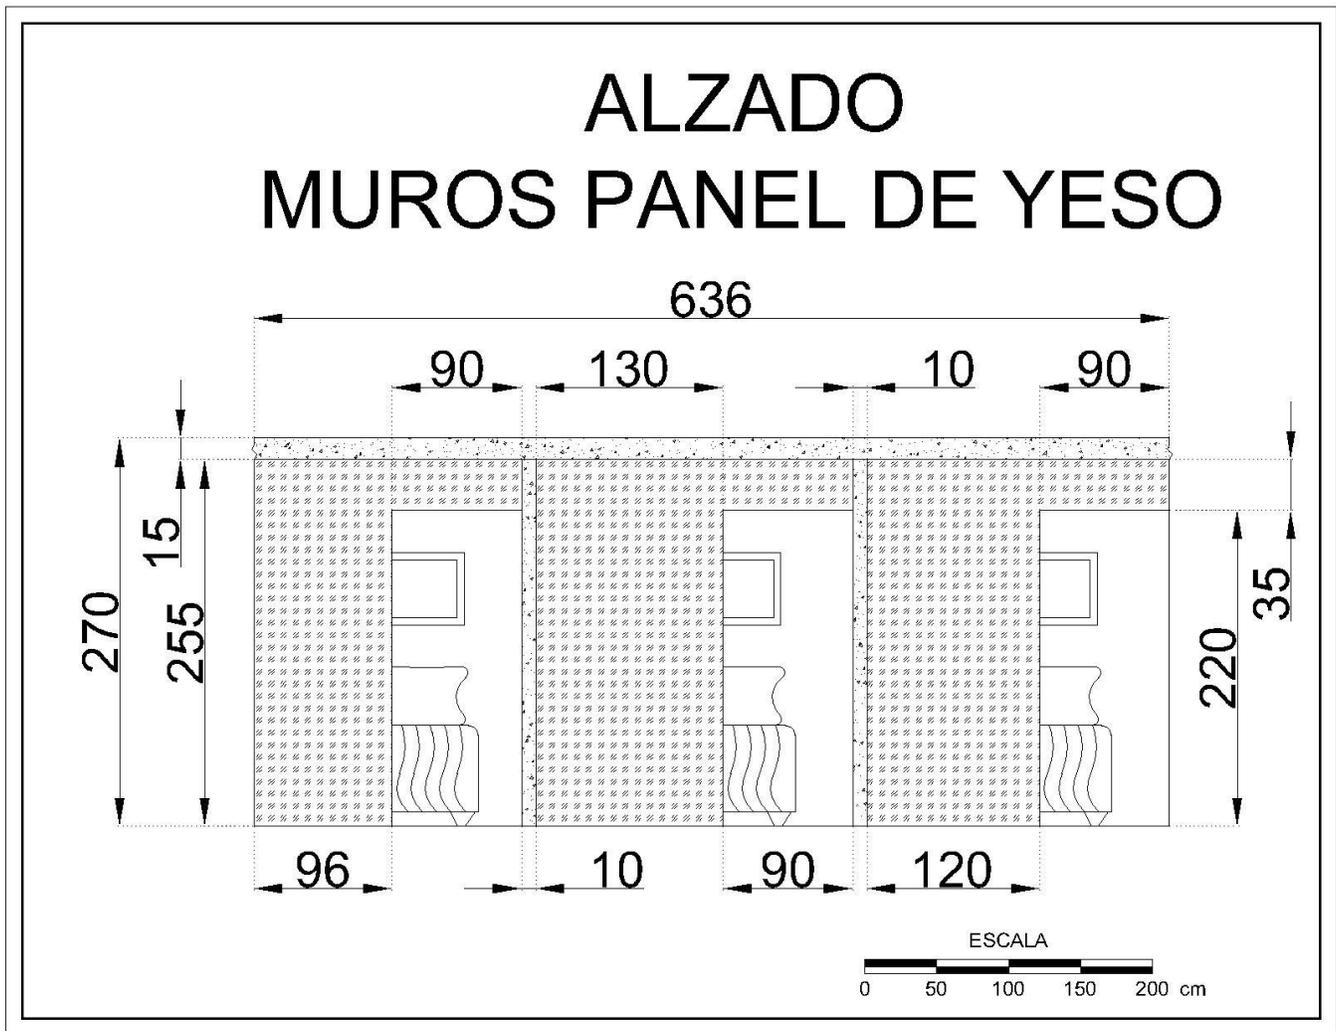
Alzado Muros con Paneles de Yeso. Recámaras.
